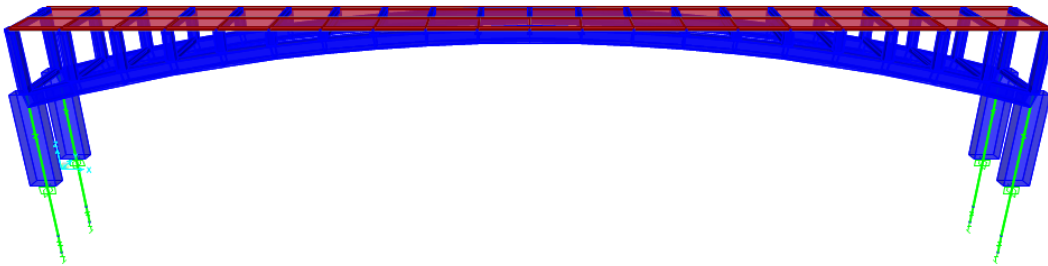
Variante 3. Fuente: elaboración propia (2022)
